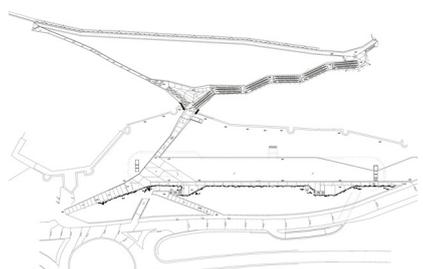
Planta de implantação Escadas de Granja, no plano urbano.
